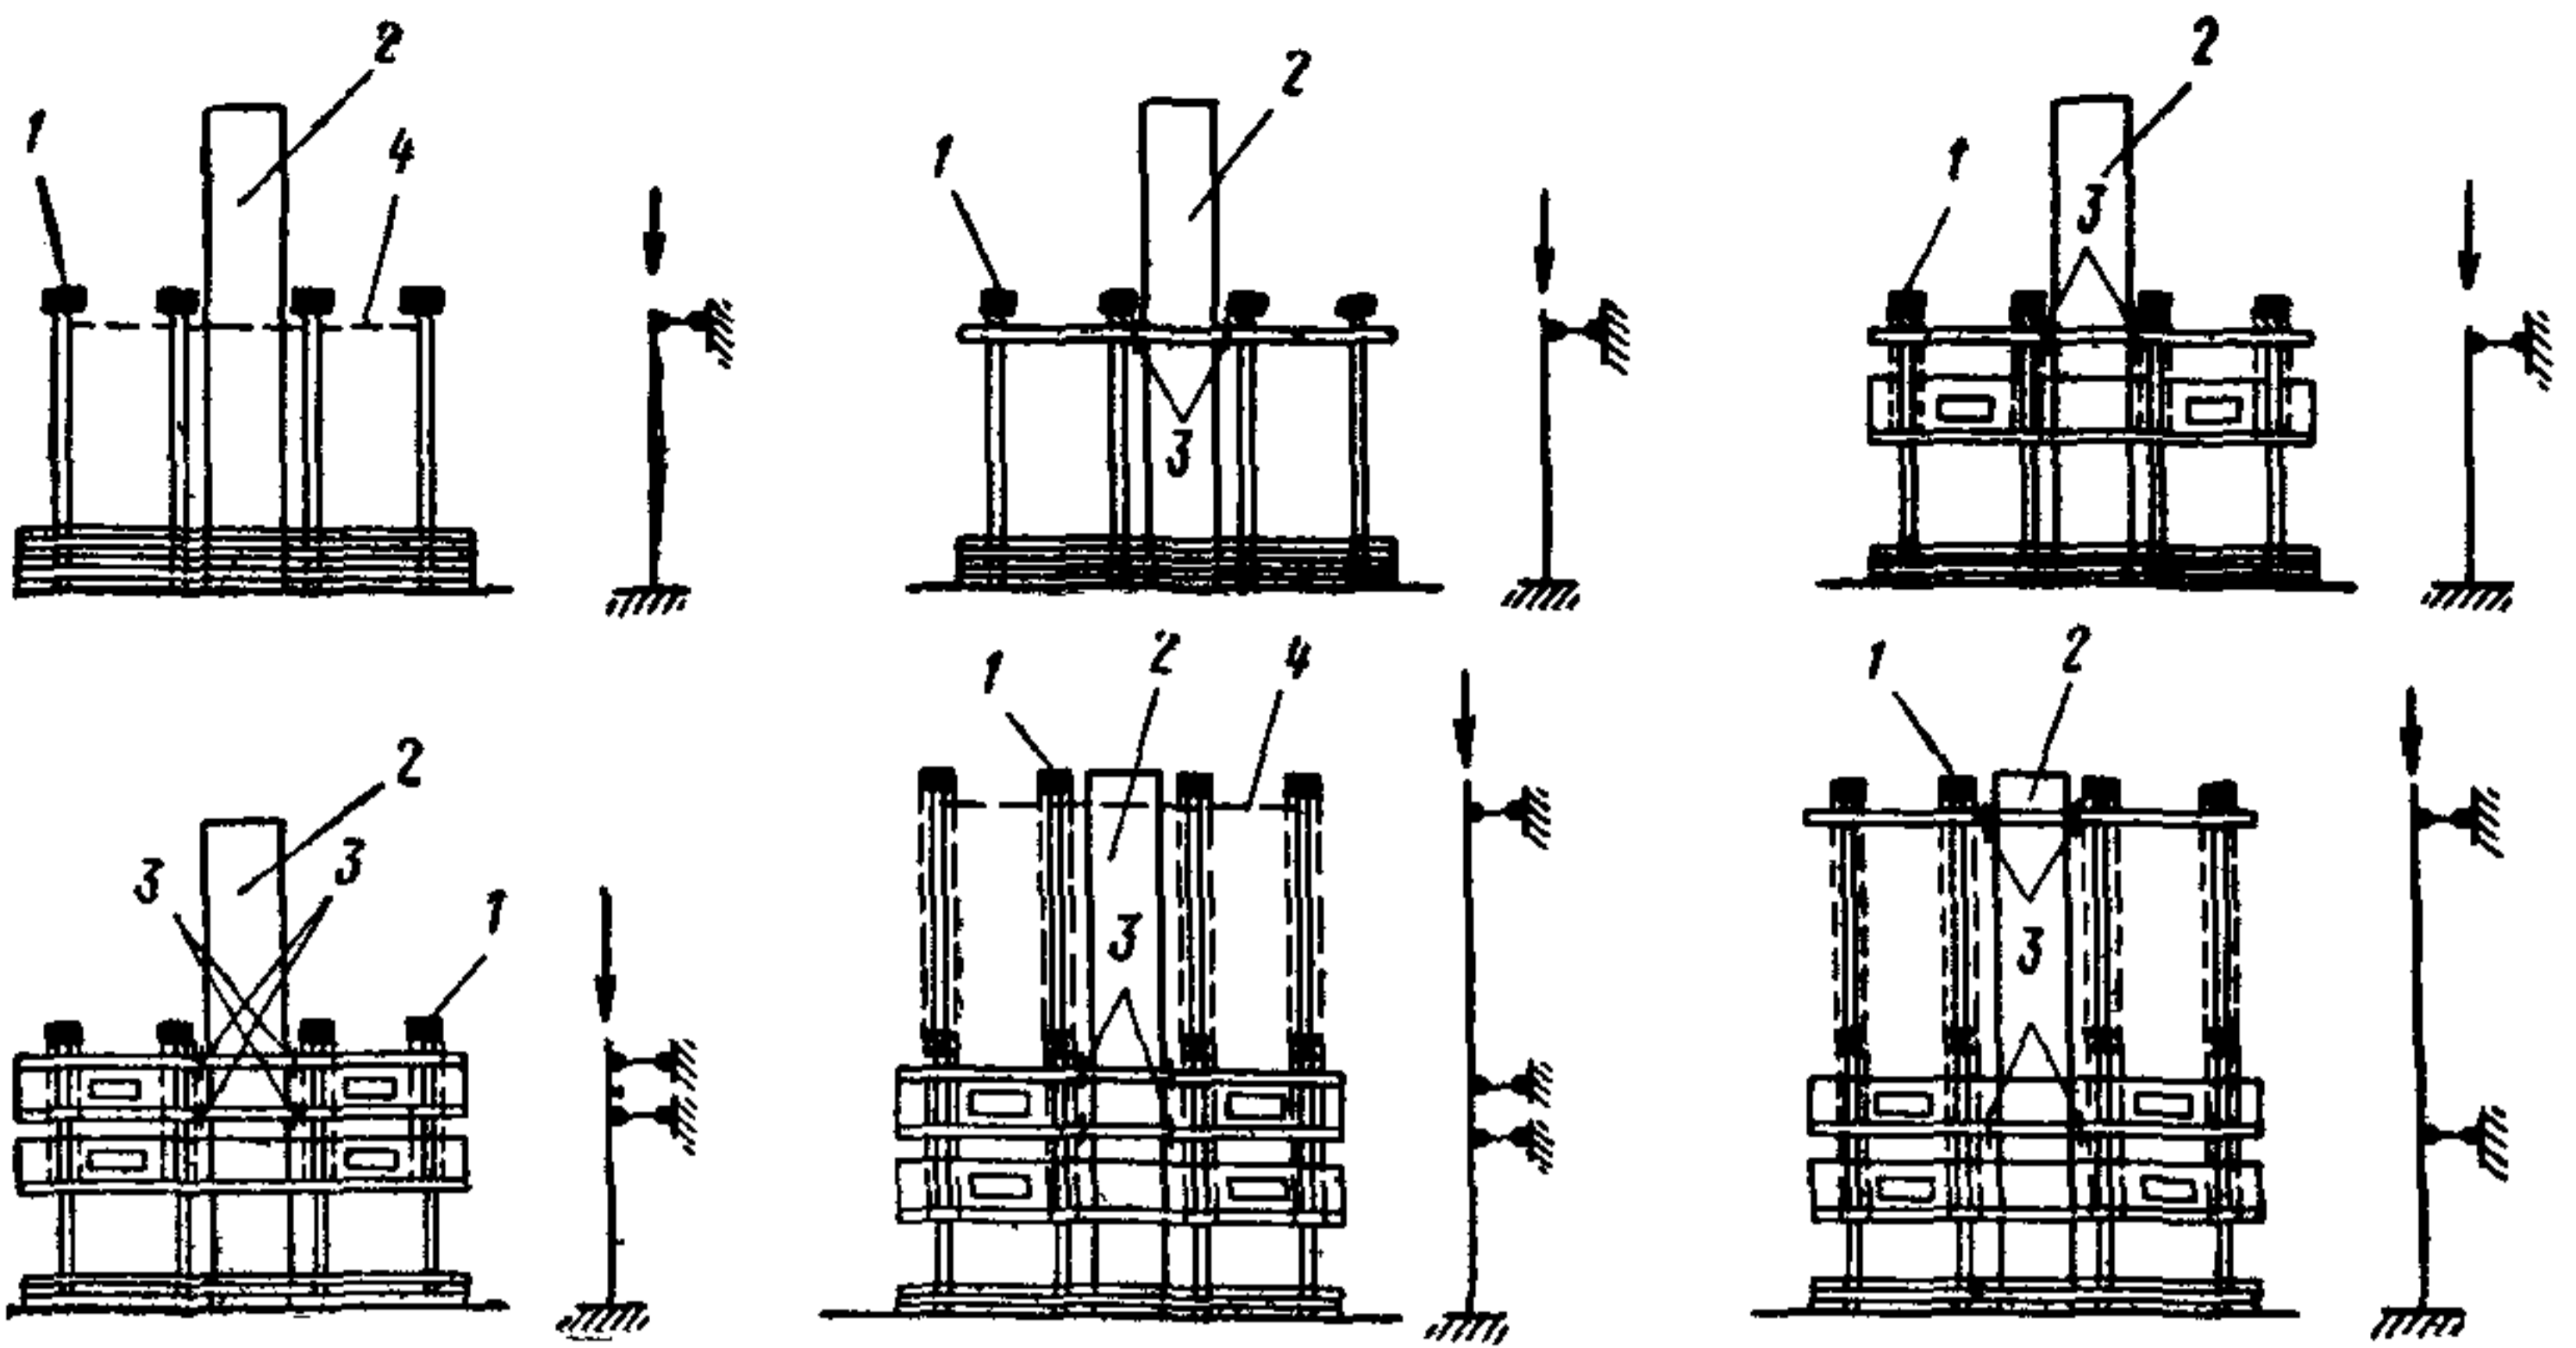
Расчетные схемы каркаса в процессе монтажа этажей
